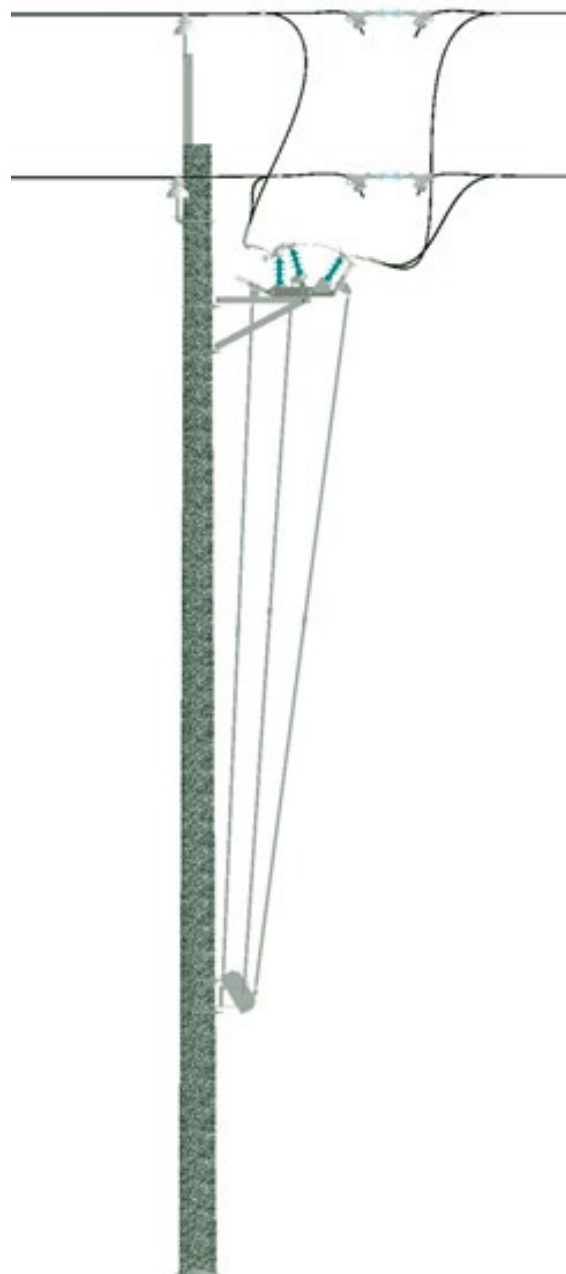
Пример установки разъединителя на промежуточную опору
